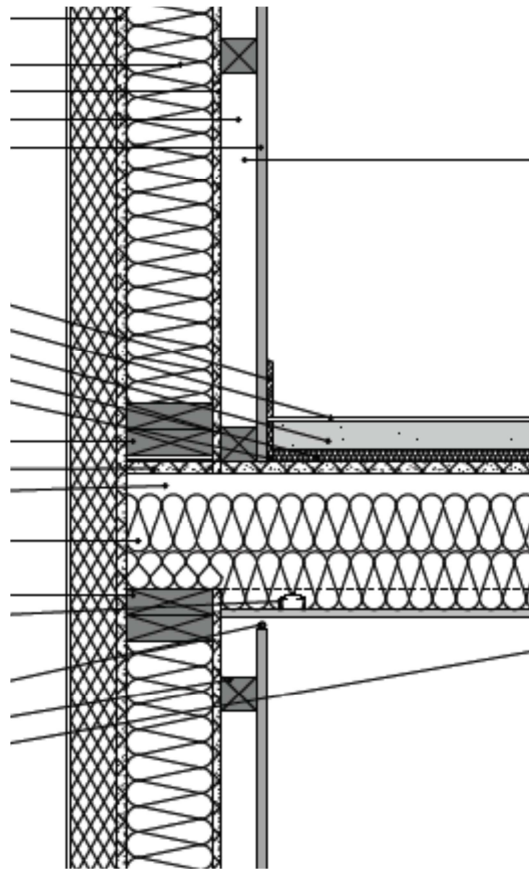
Détail de la jonction en T plancher – façade.
